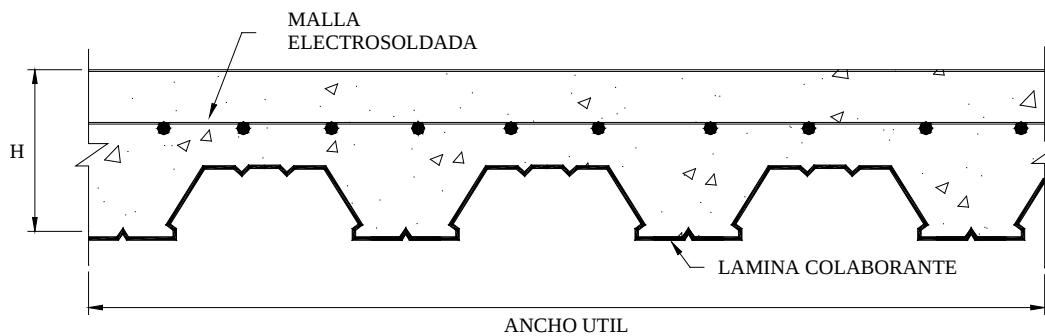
Sección típica del sistema de losa con láminas colaborantes.
